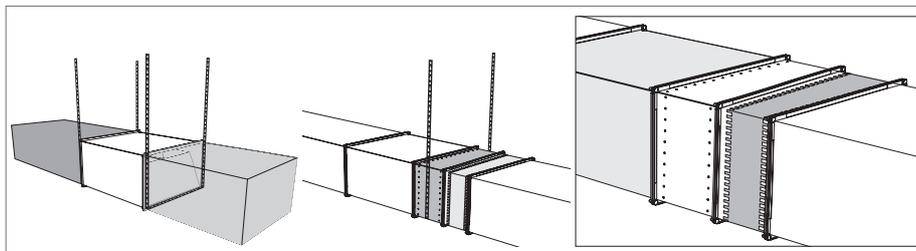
Raccordement du ventilateur au système de conduits d'air à l'aide d'accessoires. En cas d'utilisation de raccords flexibles, le ventilateur doit être fixé au sol, au mur ou au plafond à l'aide d'un conduit d'air supplémentaire.
